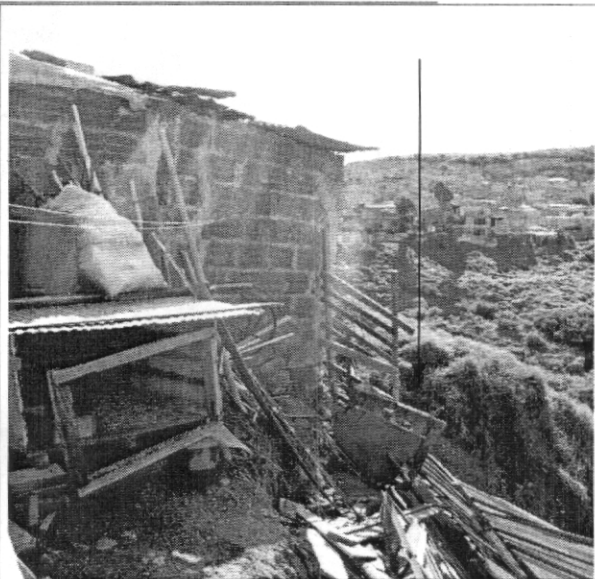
Detalle de la pendiente de la ladera mayor a 35° en la parte posterior de la vivienda
